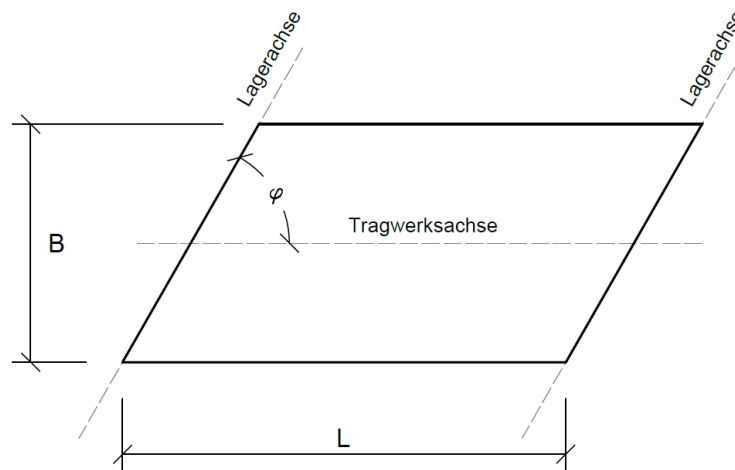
Grundriss Tragwerk mit schiefer Lagerung
